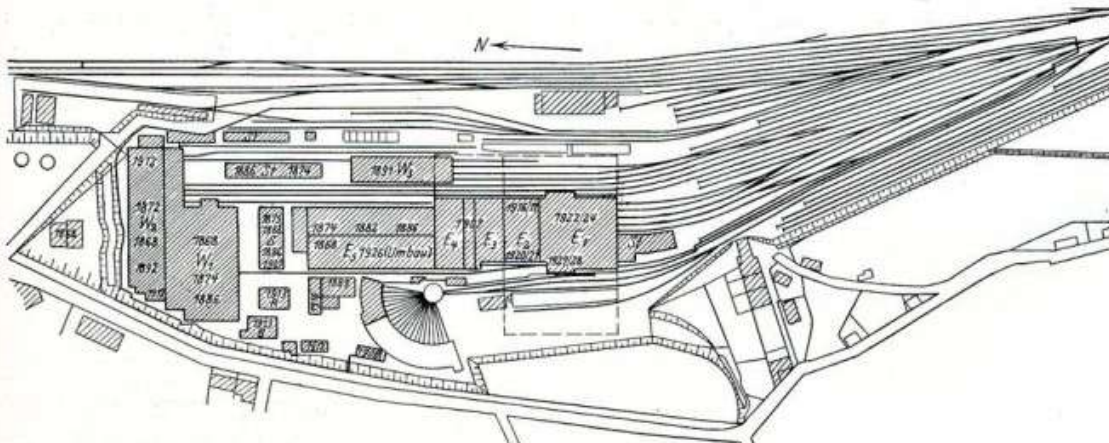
Lageplan der Jahre 1892—1928. W = Werkstätte, E = Ergänzungsbauten. (Die eingetragenen Zahlen geben die Jahre des Baufortschrittes an.)
